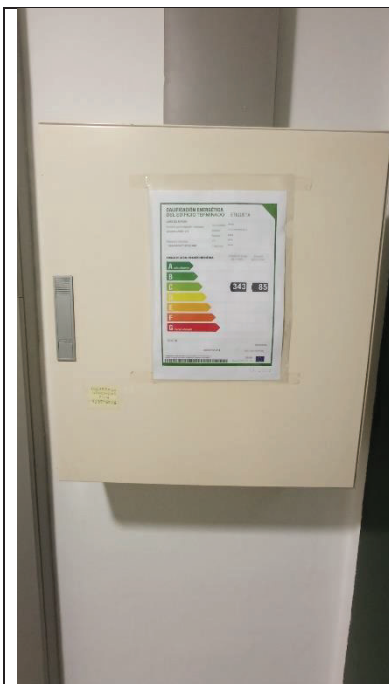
Distribución elementos en Cuadro Alumbrado y Fuerza Planta Baja.
